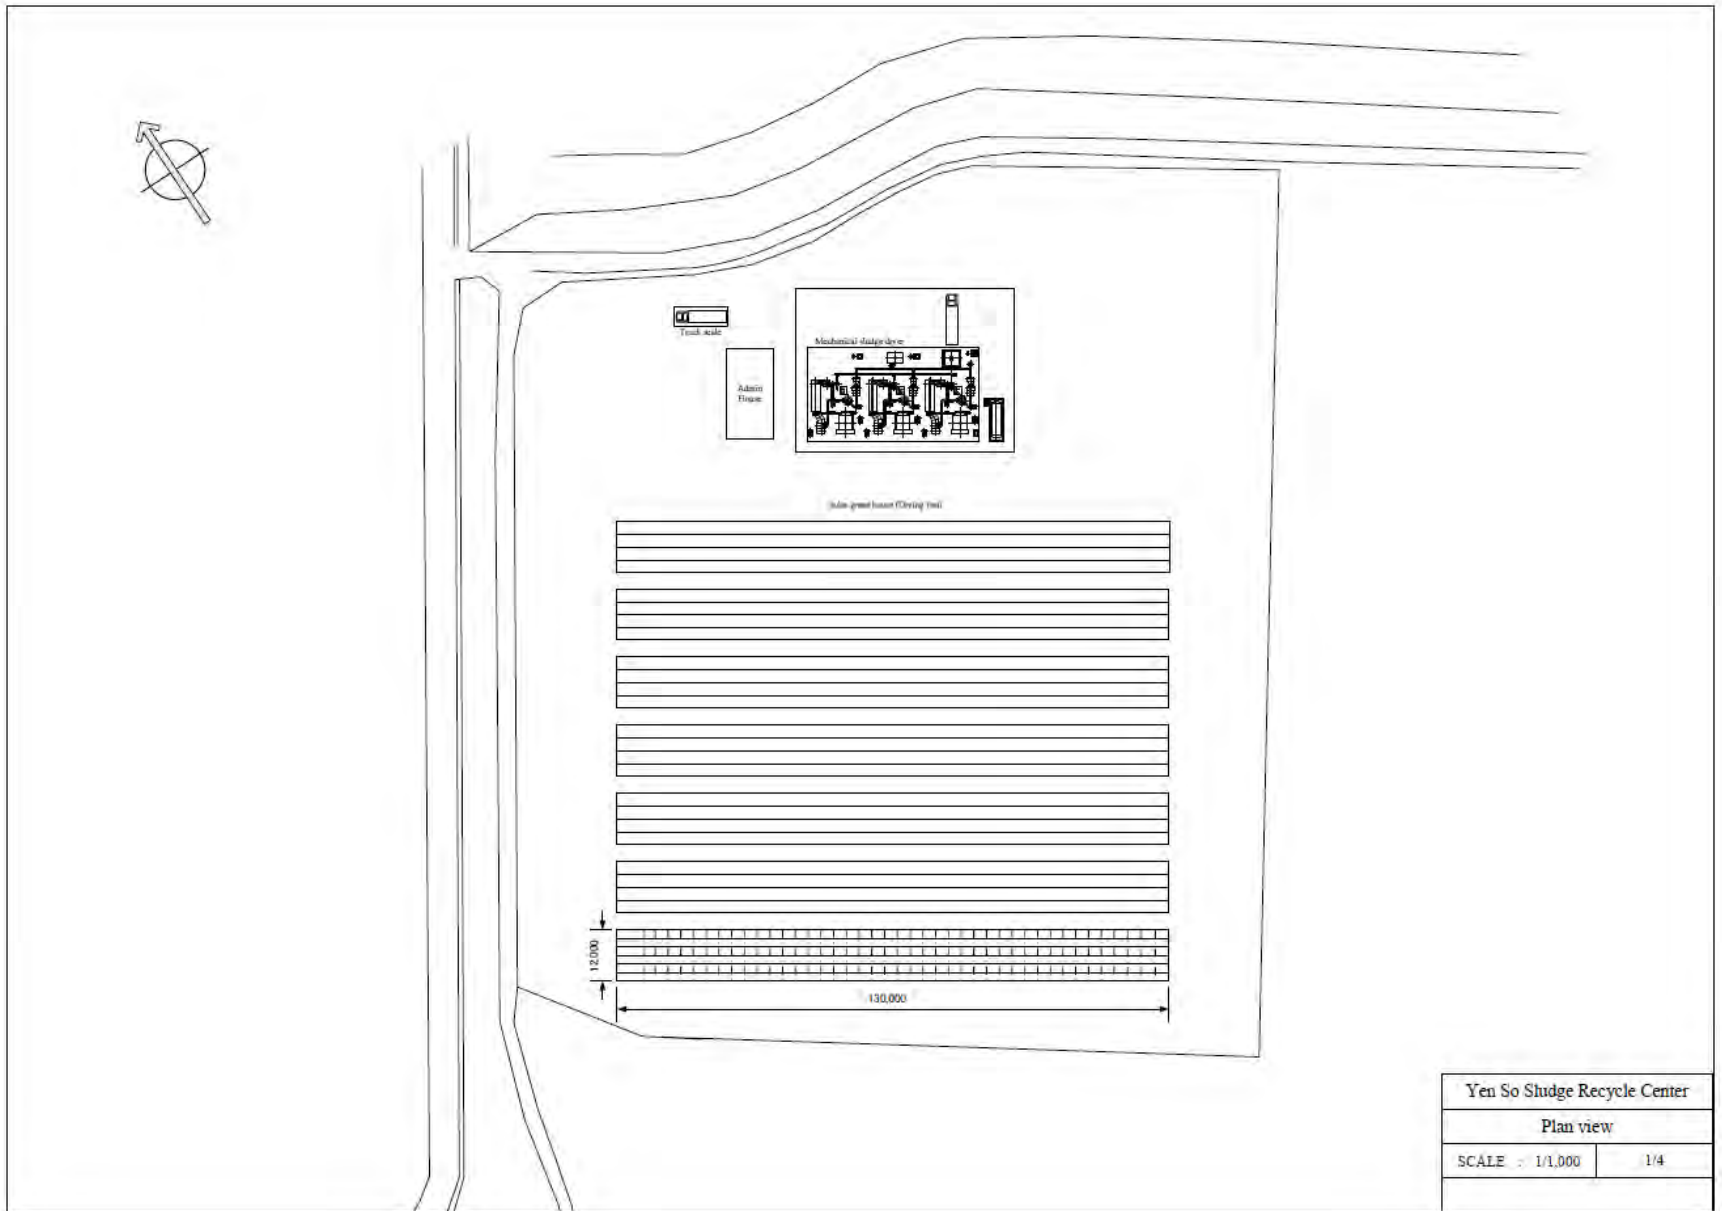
汚泥資源化センター平面配置図 (出典：JICA 調査団)
